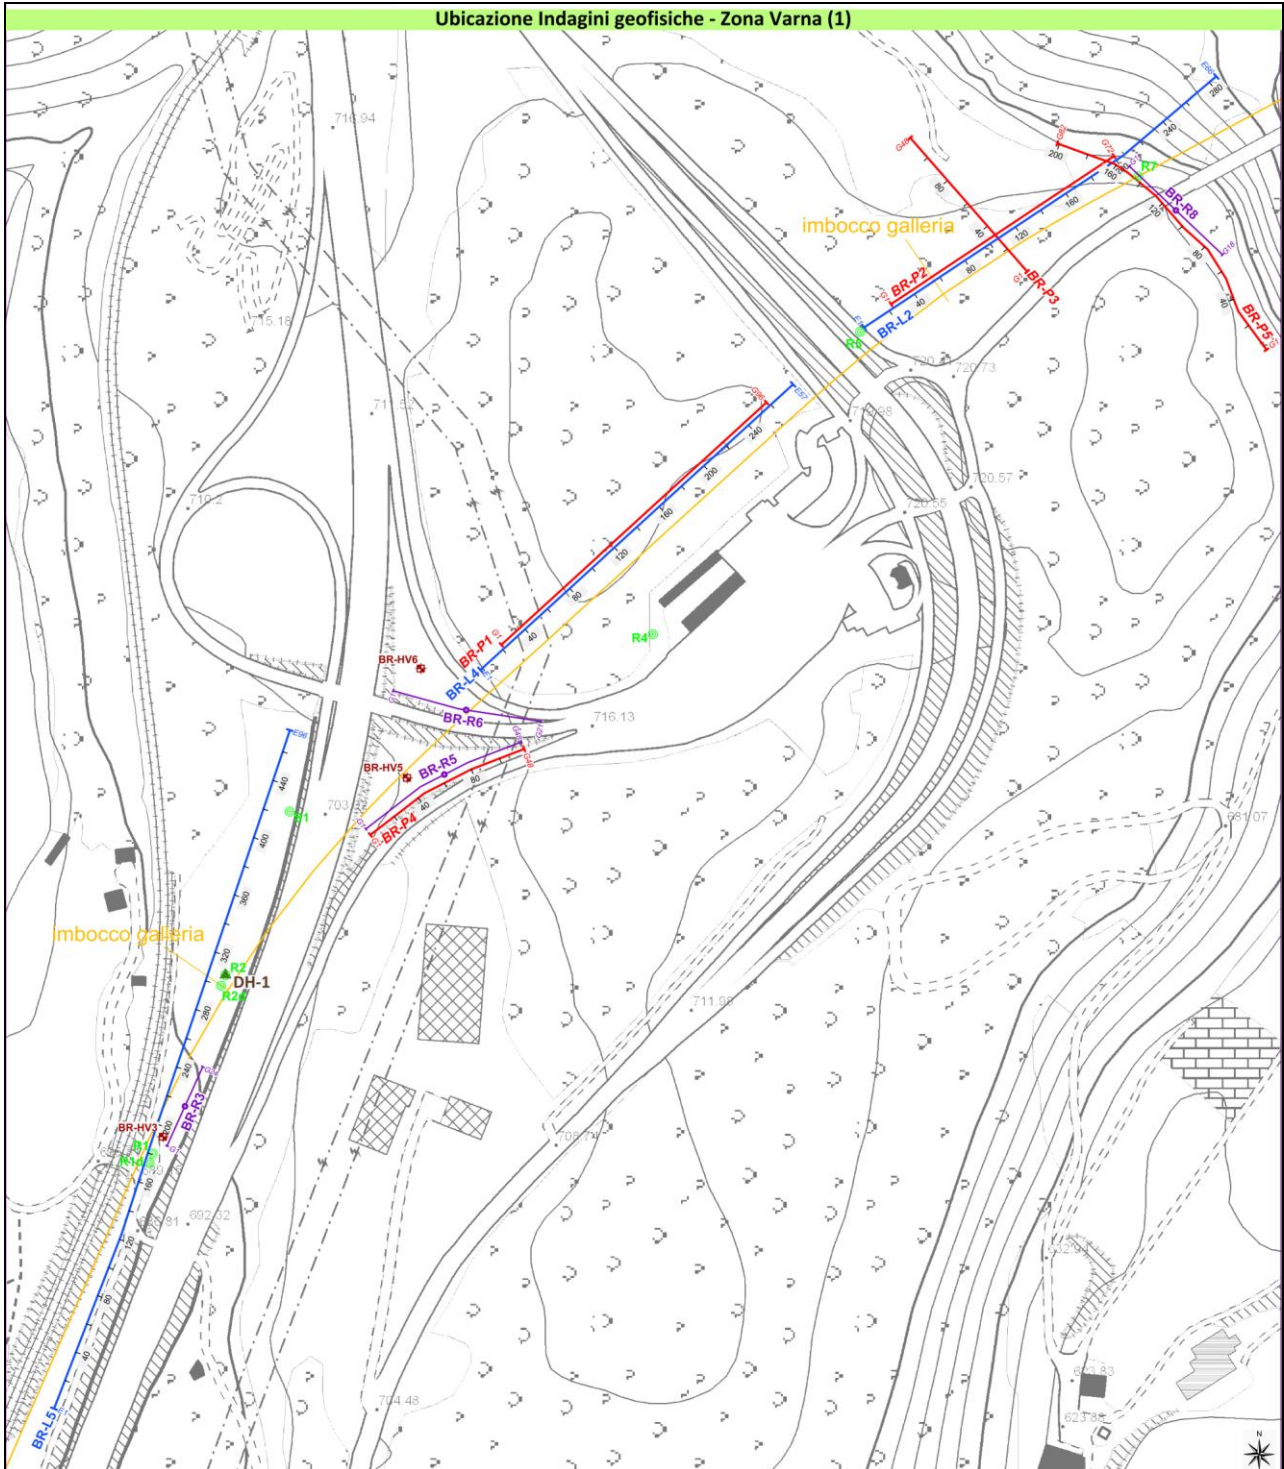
Estratto planimetrico delle indagini effettuate – Zona Varna.
